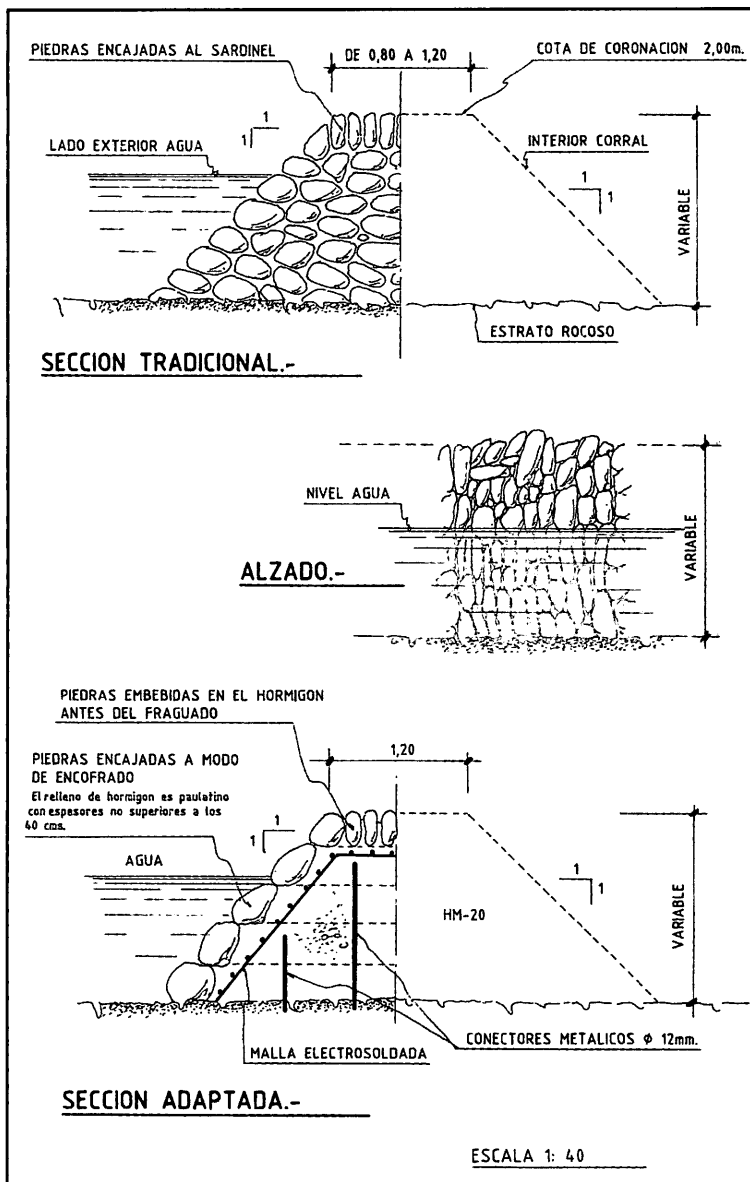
Secciones del muro: tradicional y moderna con núcleo de hormigón no visible.
